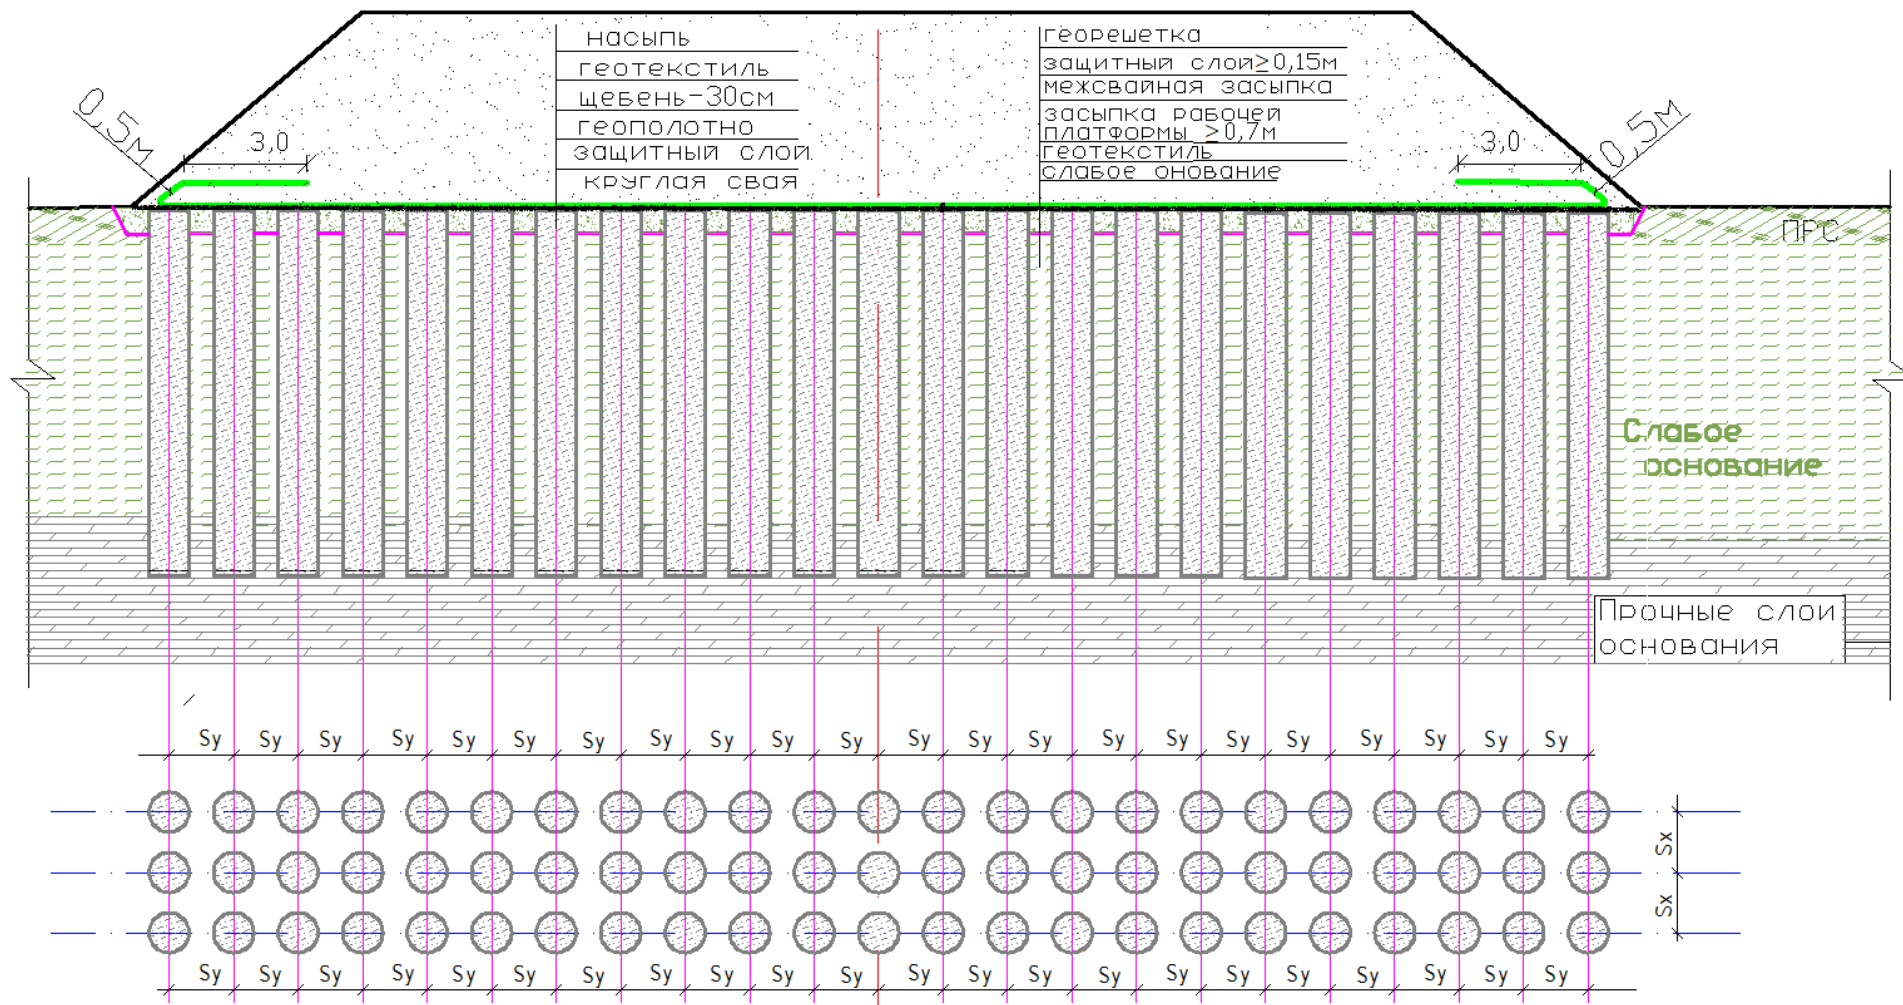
Гибкий ростверк из одного слоя геополотна на круглых сваях (с размещением свай по квадратной сетке)
